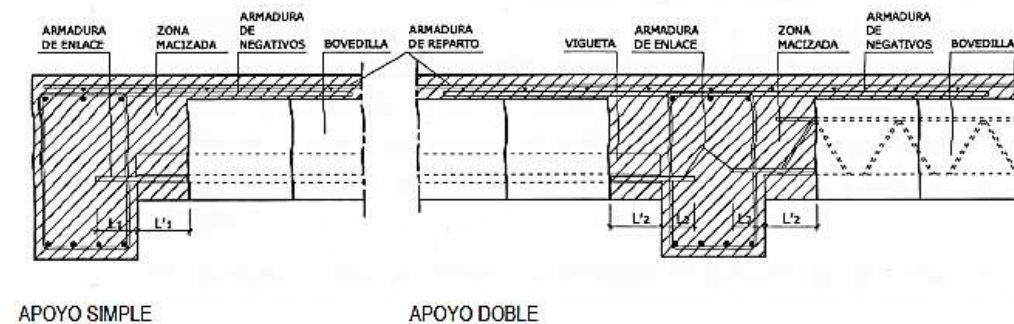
Detalle del apoyo directo por solapo de las viguetas con la viga
